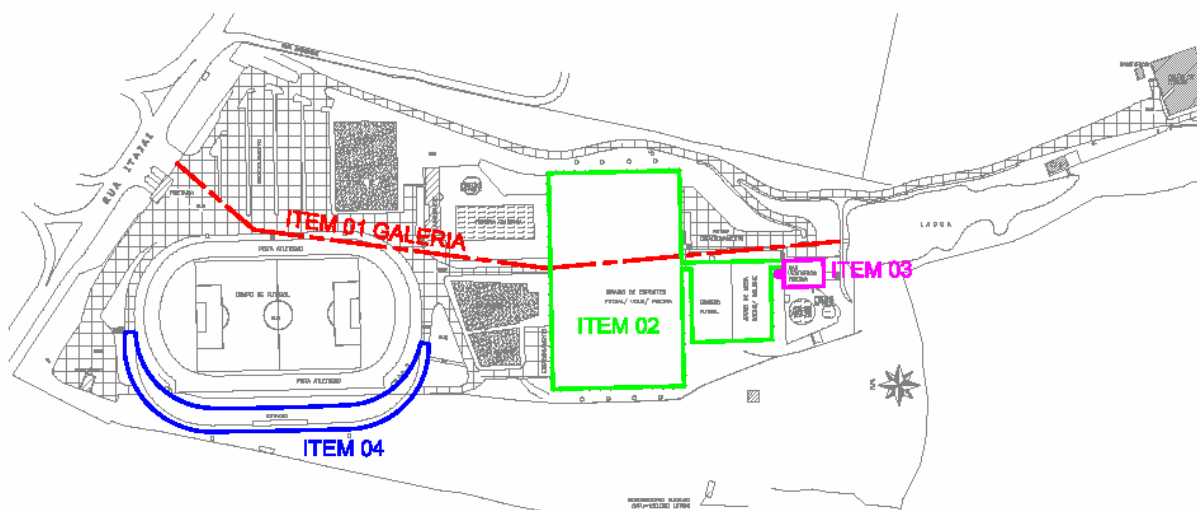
Vista em planta das edificações objeto dos trabalhos
